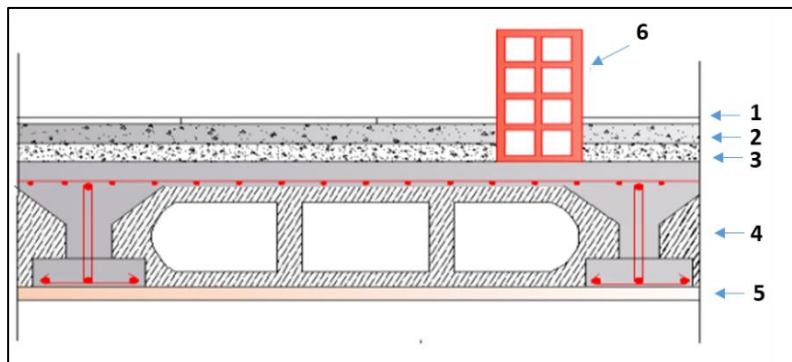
Coupe verticale d'un plancher à corps creux de l'étage courant.
